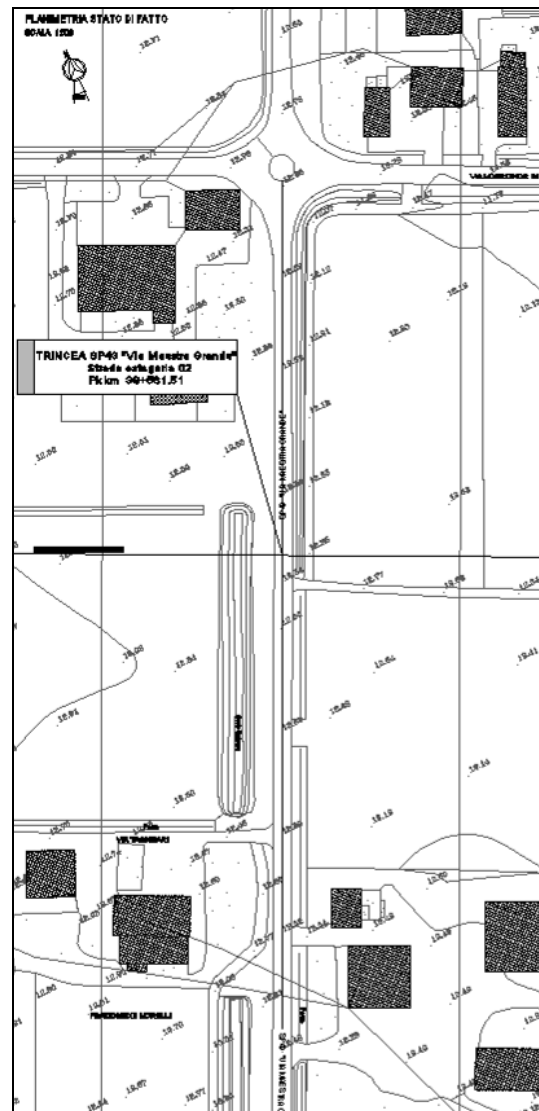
PLANIMETRIA STATO DI FATTO (FUORI SCALA).
